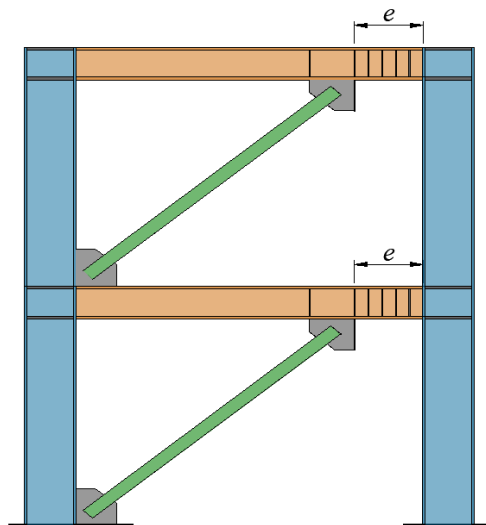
Conexión eslabón-columna
